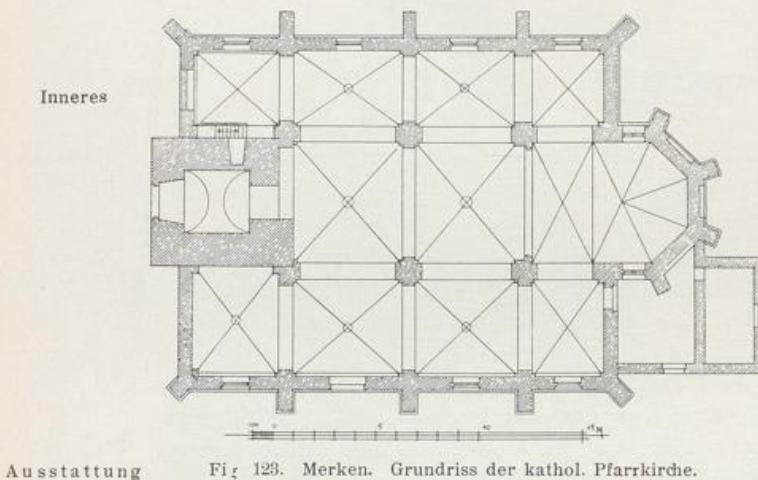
Merken. Grundriss der kathol. Pfarrkirche.
